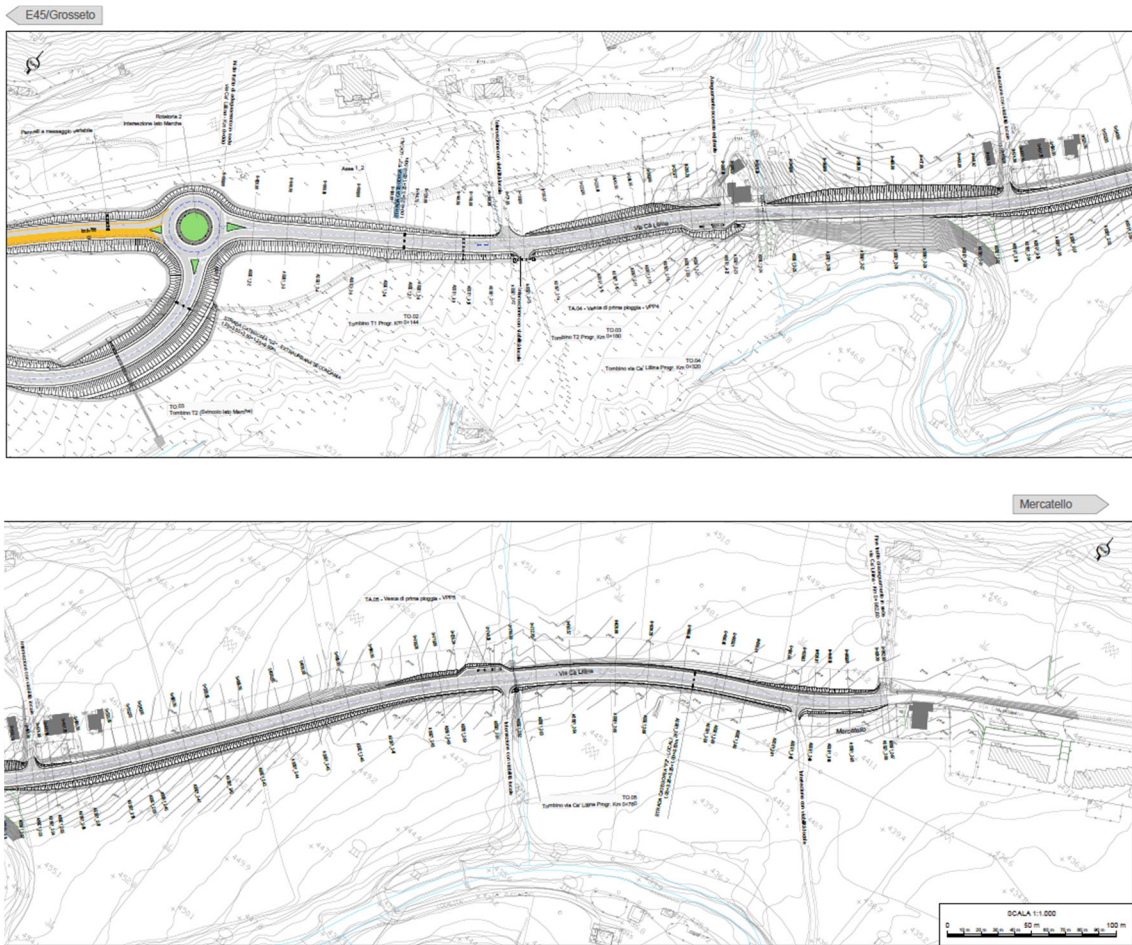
Collegamento alla viabilità esistente lato Marche – Progetto Esecutivo
